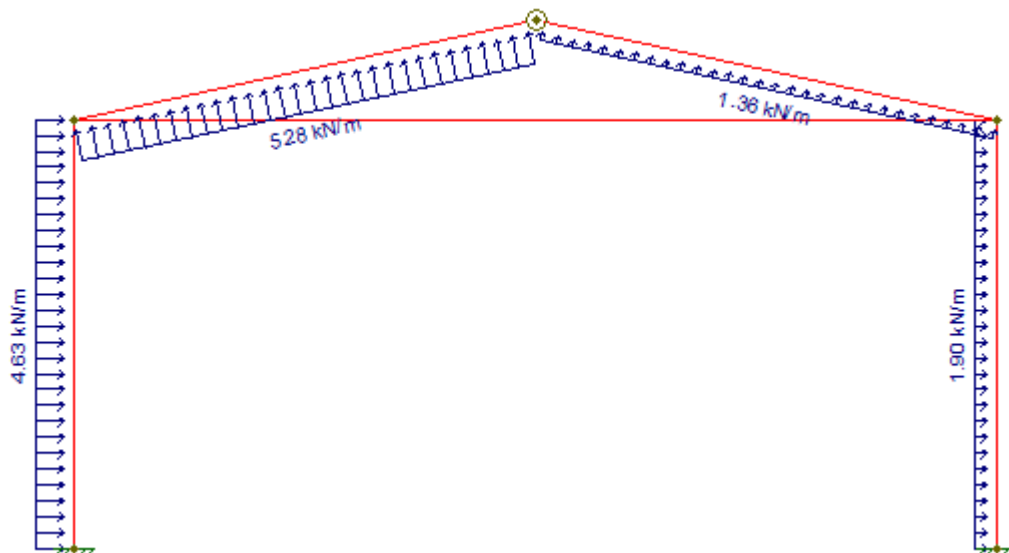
Sobrepressão no Telhado e Sucção no Telhado Vento a 90°
